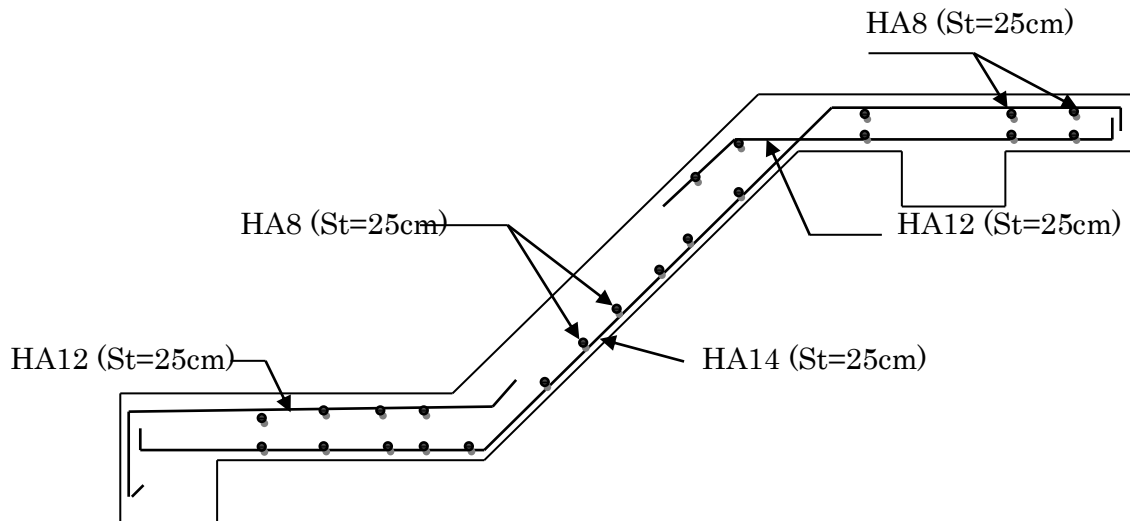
Schéma de ferrailage des escaliers de l'entre sol2 jusqu'aux 5^{ème} étage
